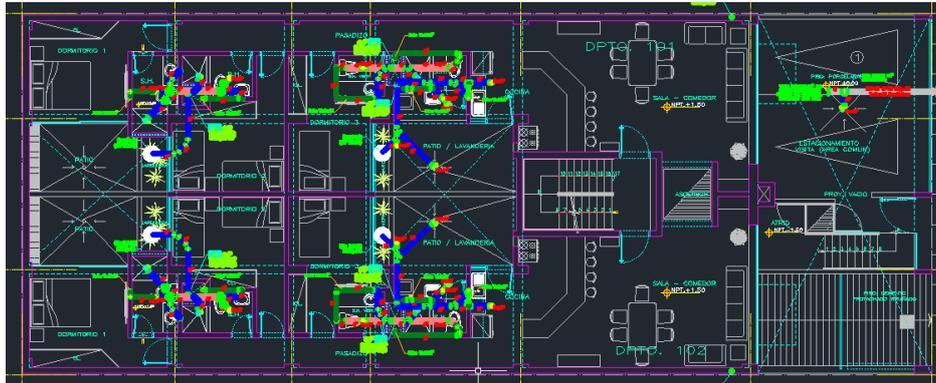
Plano Instalaciones Sanitarias 2D edificio Spuknit - Surco
